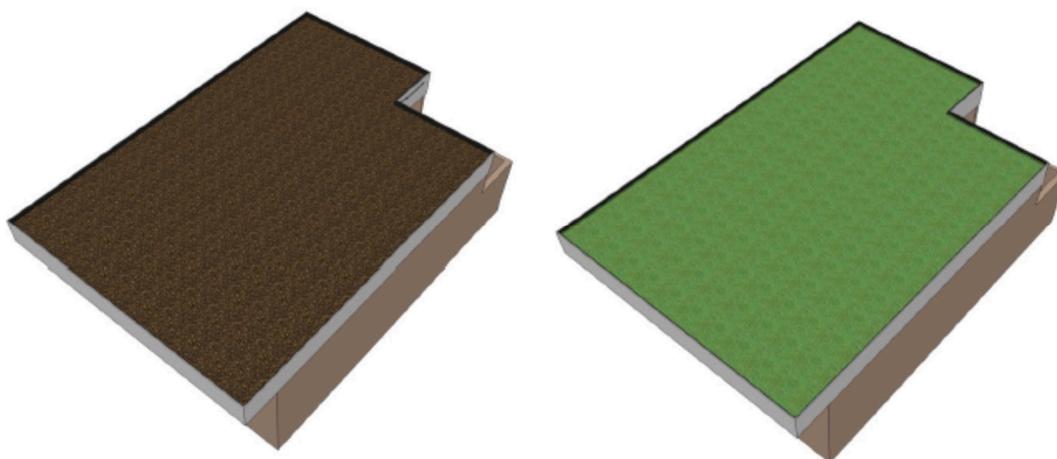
Telhado verde sistema modular – camada de substrato e telhado verde sistema modular vegetado.
